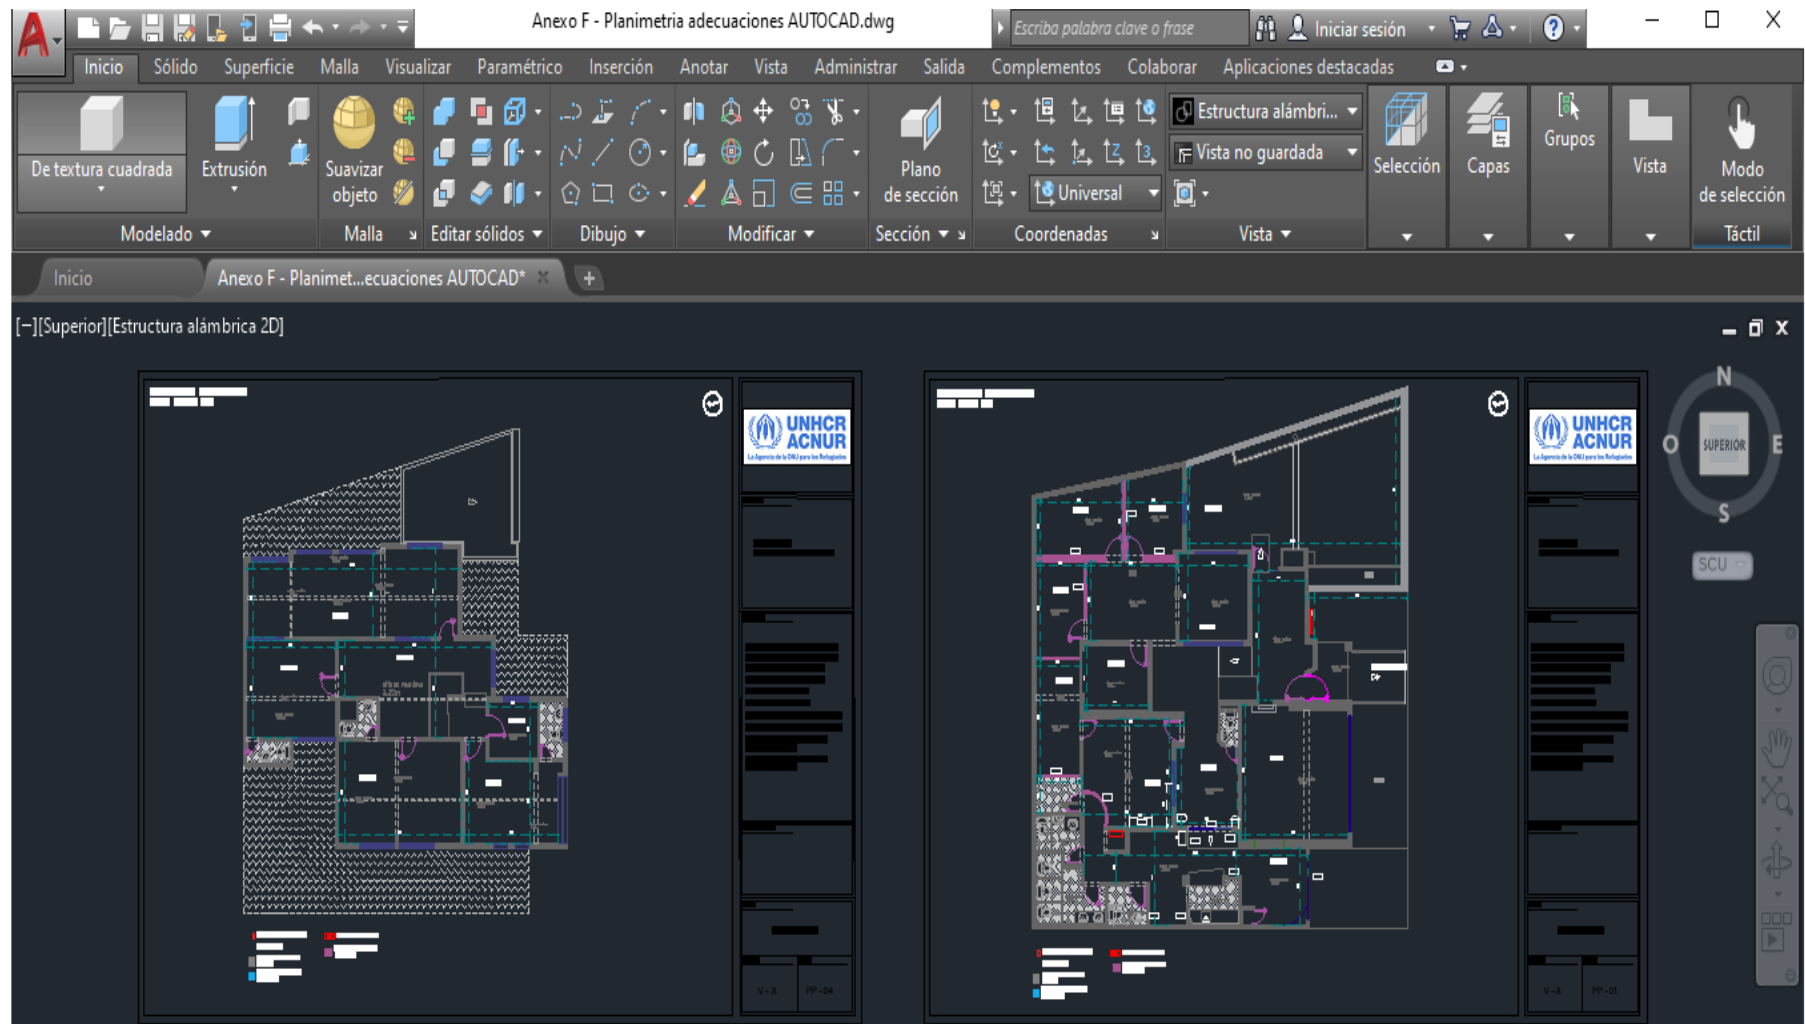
Revisión Anexo F - Planos AutoCAD. Fuente ACNUR.
